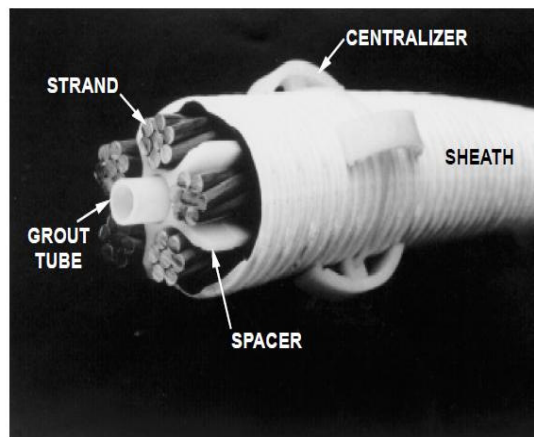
Detalle de una sección de cable para anclaje. (Fuente: United States Department of Transportation. Geotechnical Engineering Circular No.4)
